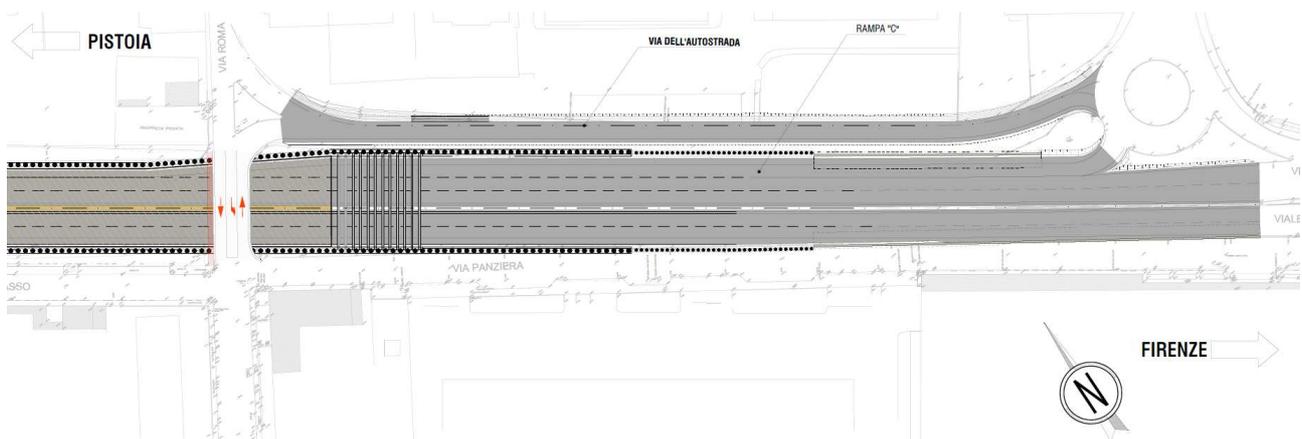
Stralcio planimetrico con individuazione della rampa "C" e di via dell'Autostrada
